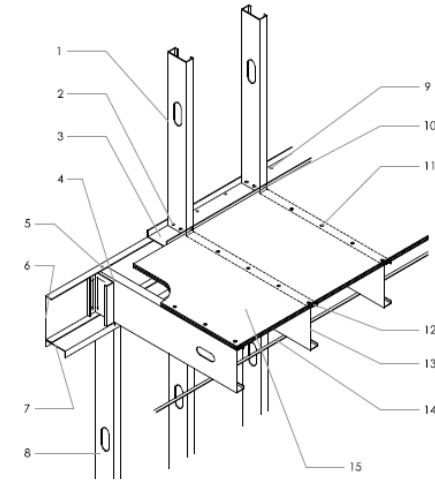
Detalle constructivo sistema Steel framing, armado de pared y entrepiso. Fuente: Arq. Augusto Samaniego
